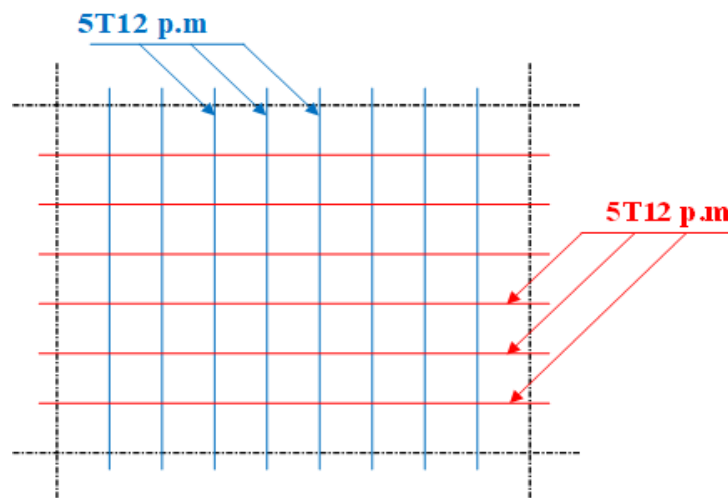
Disposition du ferrailage dans les voiles ($e = 15 \text{ cm}$)
